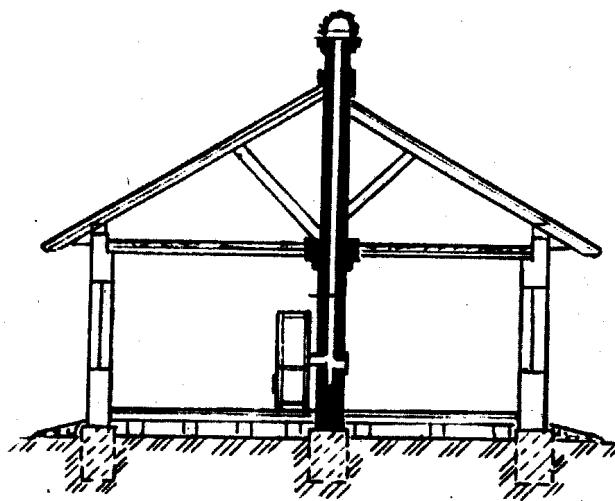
Подсоединение каркасной печи к дымовой трубе или дымовому каналу
